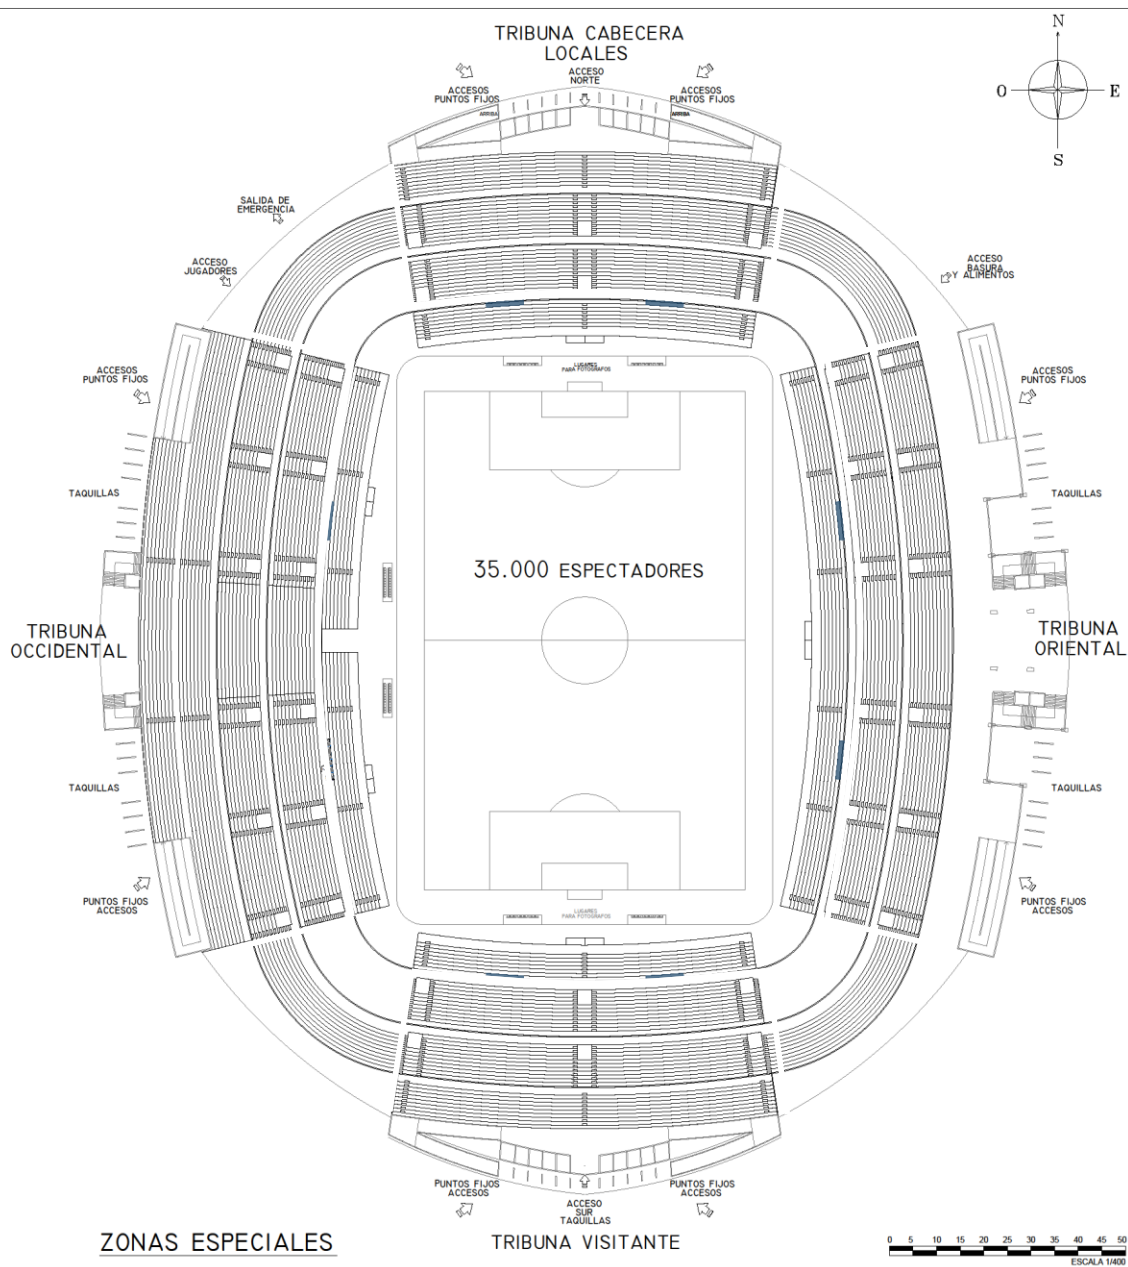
Plano Ubicación Discapitados /Fuente Elaboracion Propia
